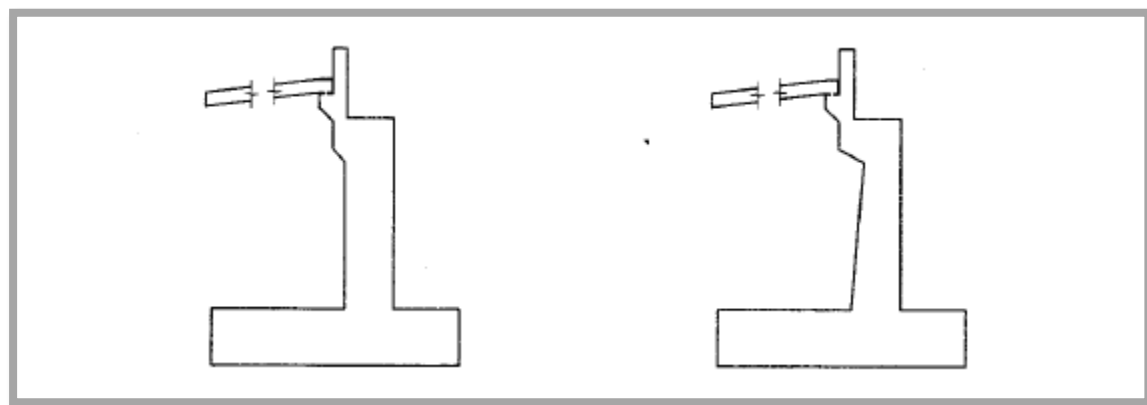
Sección transversal tipo. Estribo Cerrado
